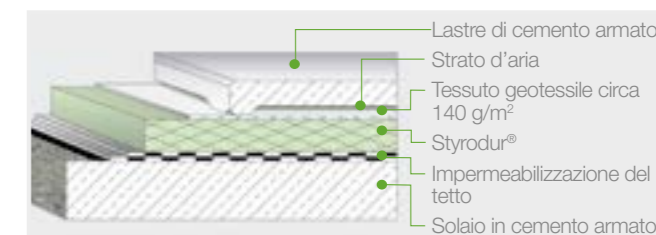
Tetto a parcheggio con lastre di cemento armato di grande formato, rialzate.
